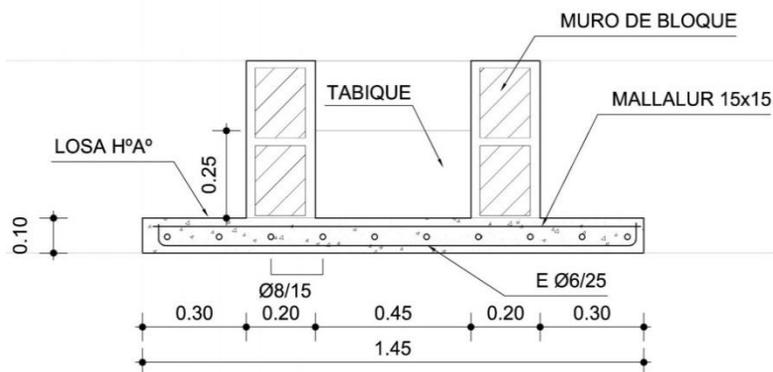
Sistema tipo de tratamiento para lavado de equipos de fabricación y colocación de hormigón fresco
